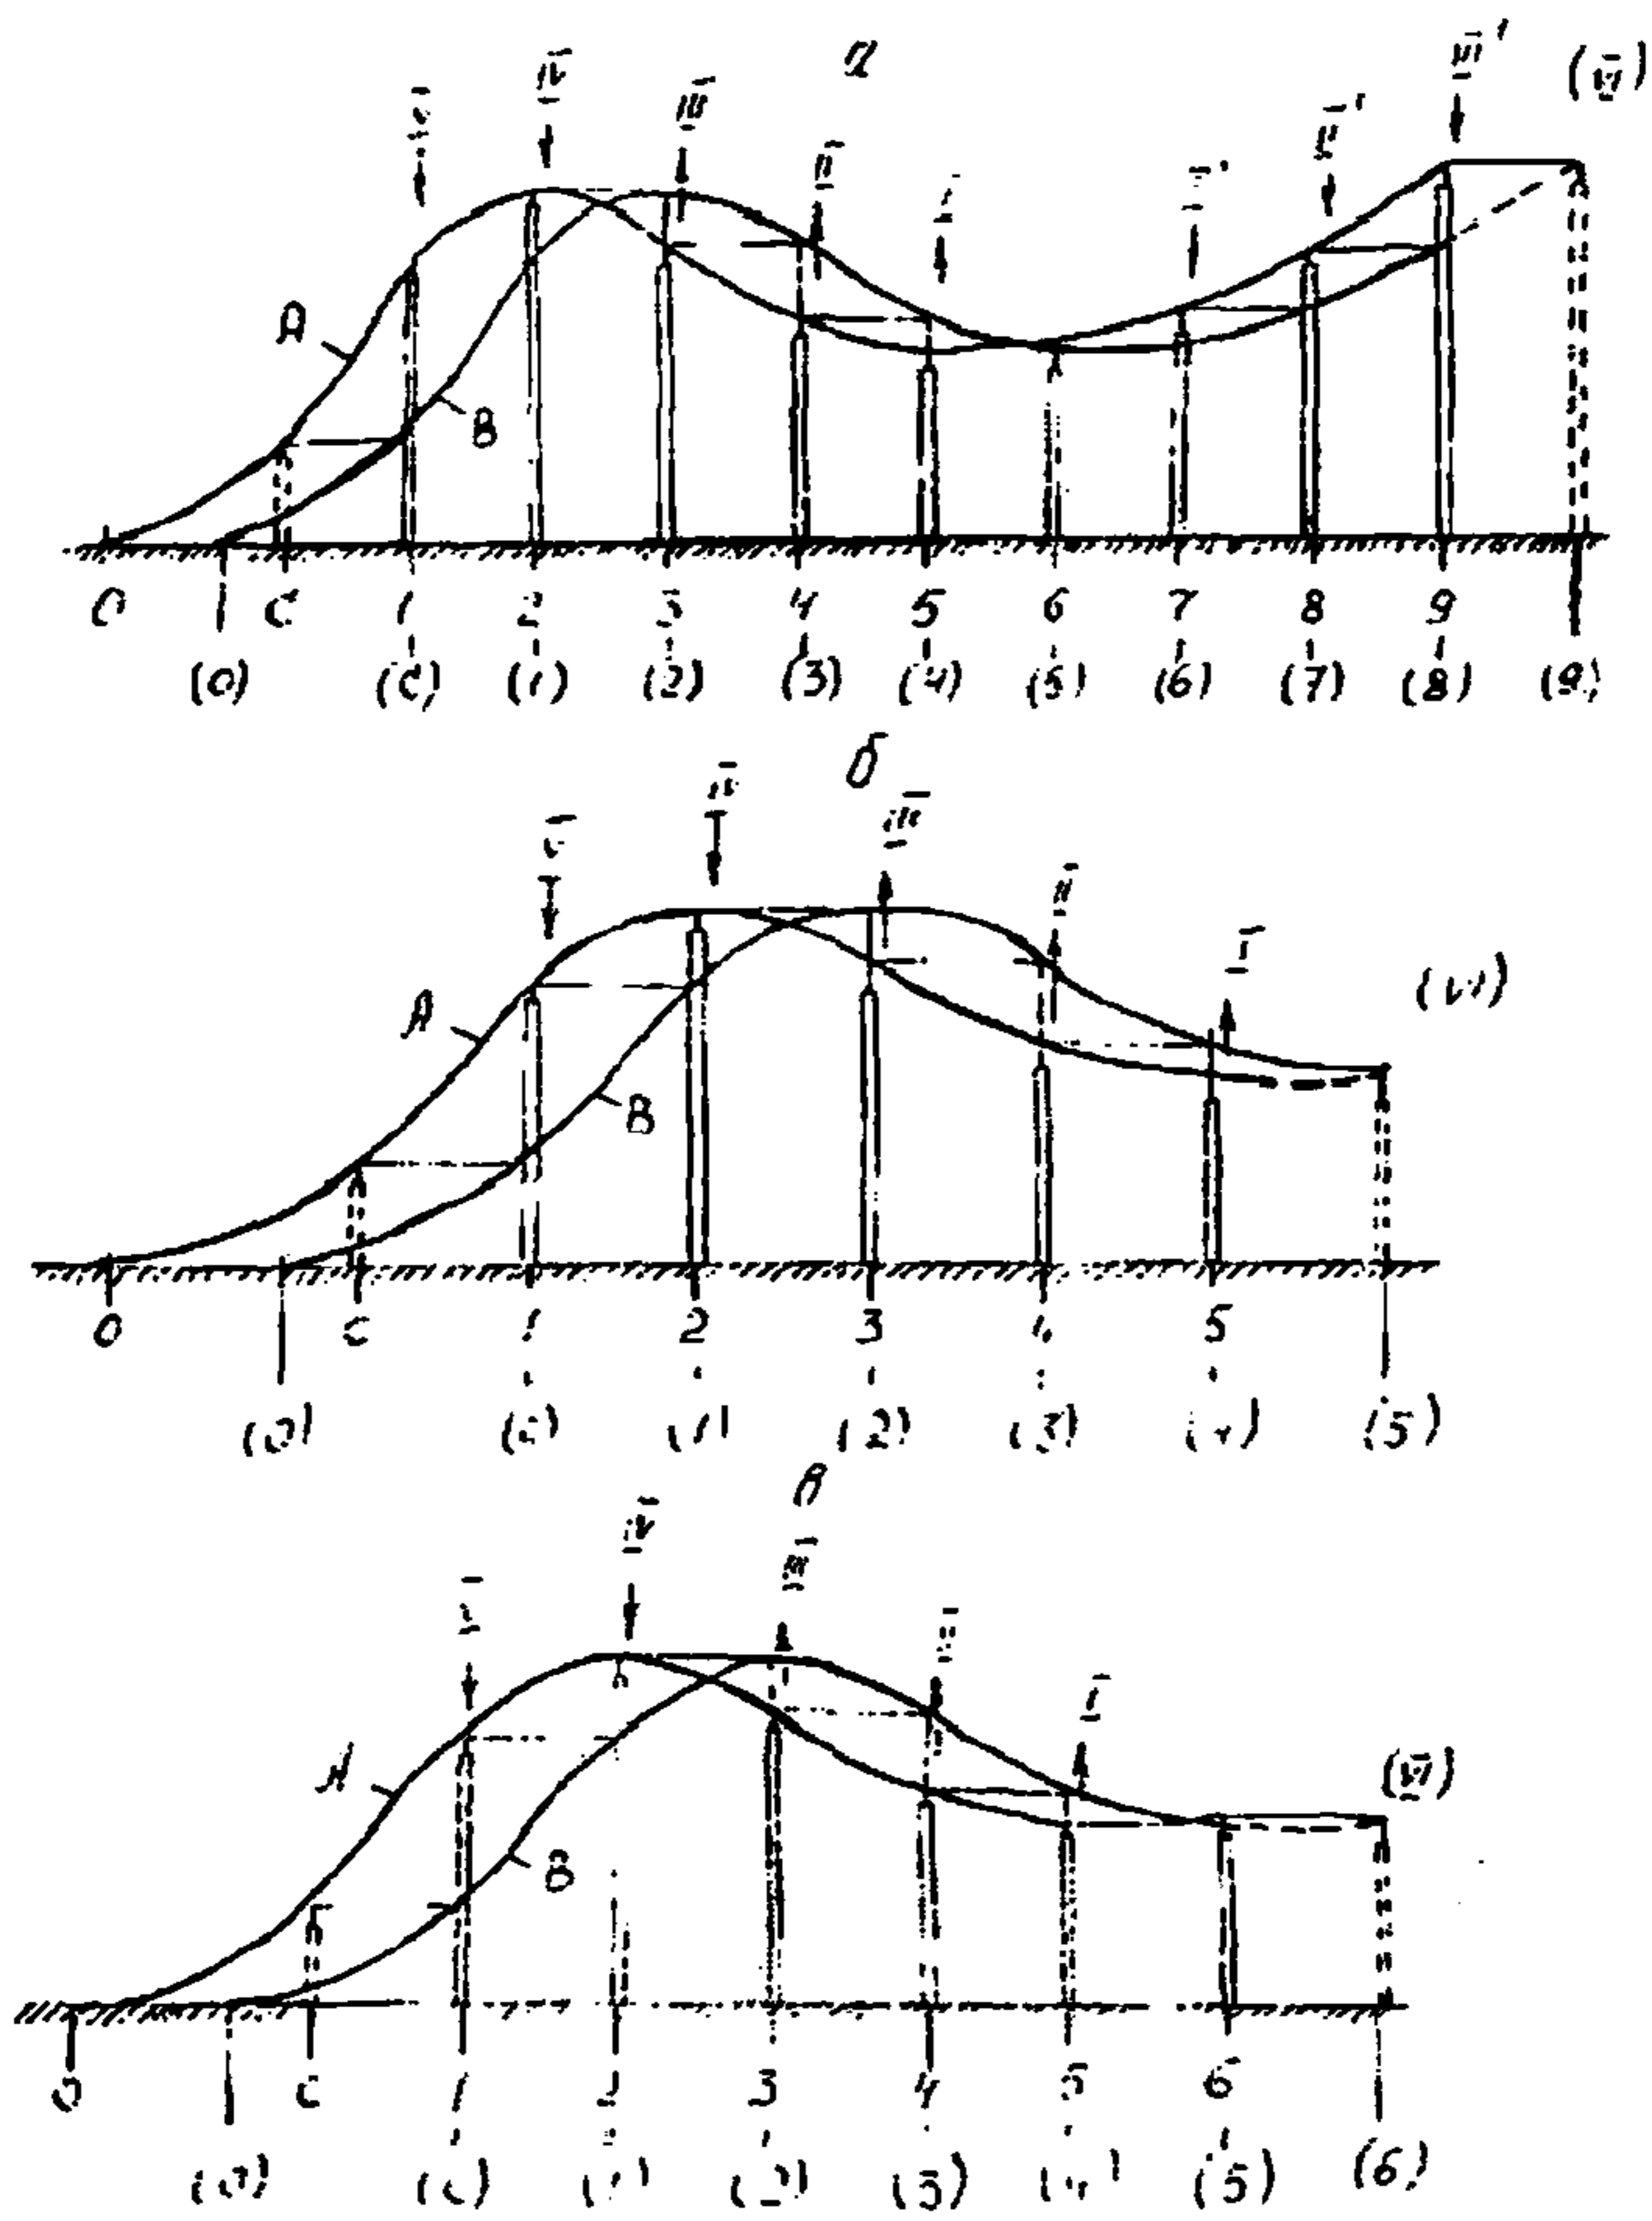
Последовательность перенастройки схем для выполнения очередного цикла сборки и сварки трубопровода:
